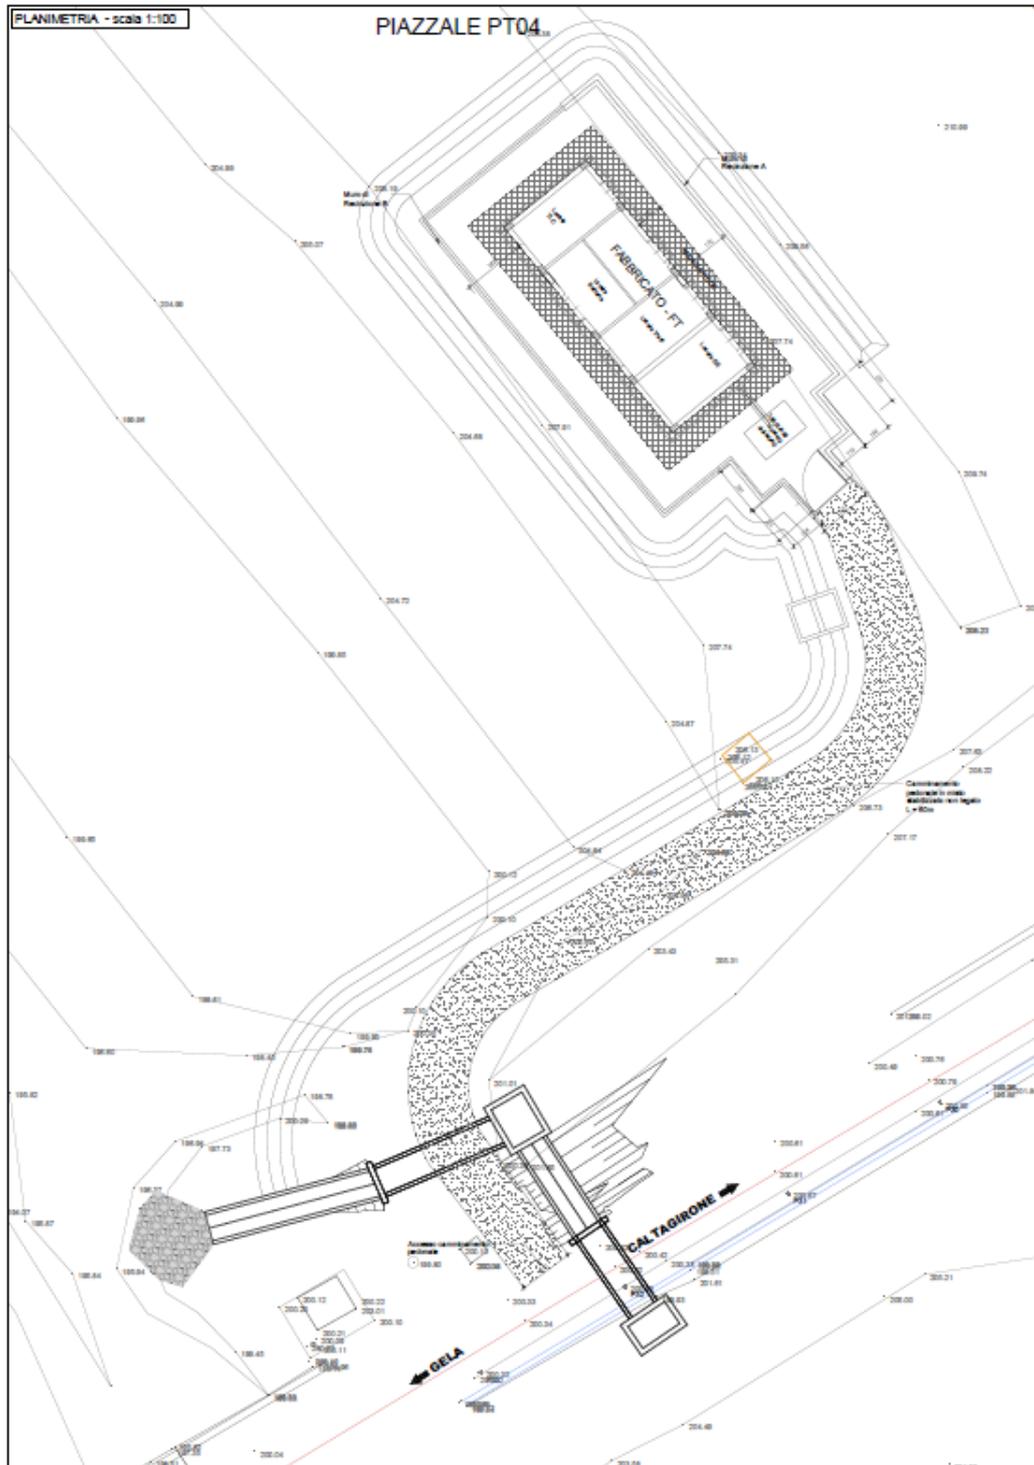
PT04 Planimetria piazzale GA dell'Arcia imbocco sud
